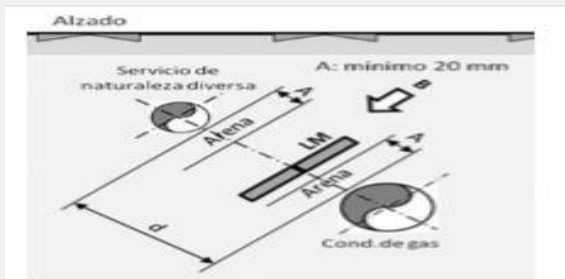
Instalación ladrillo macizo en paralelo (alzado)
